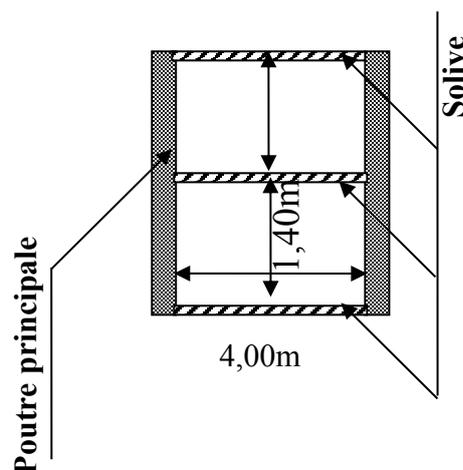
Espacement entre les poutres et solives (entraxe)
